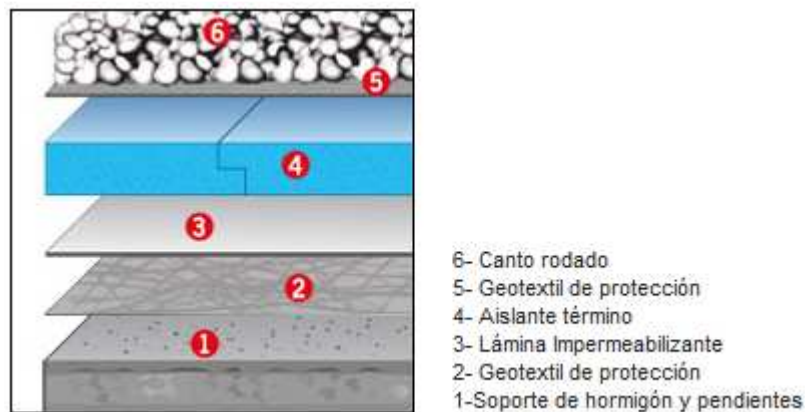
Capas de la cubierta plana invertida no transitable.
